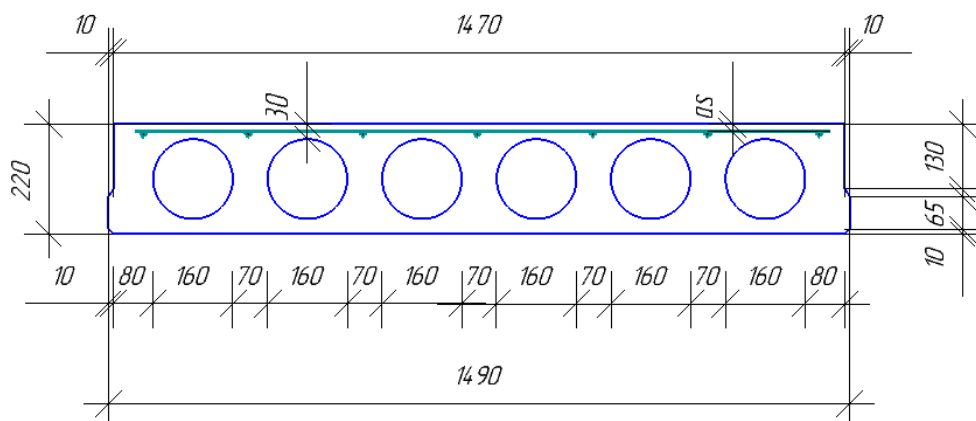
Схема расположения сетки С-1 в поперечном сечении панели.
